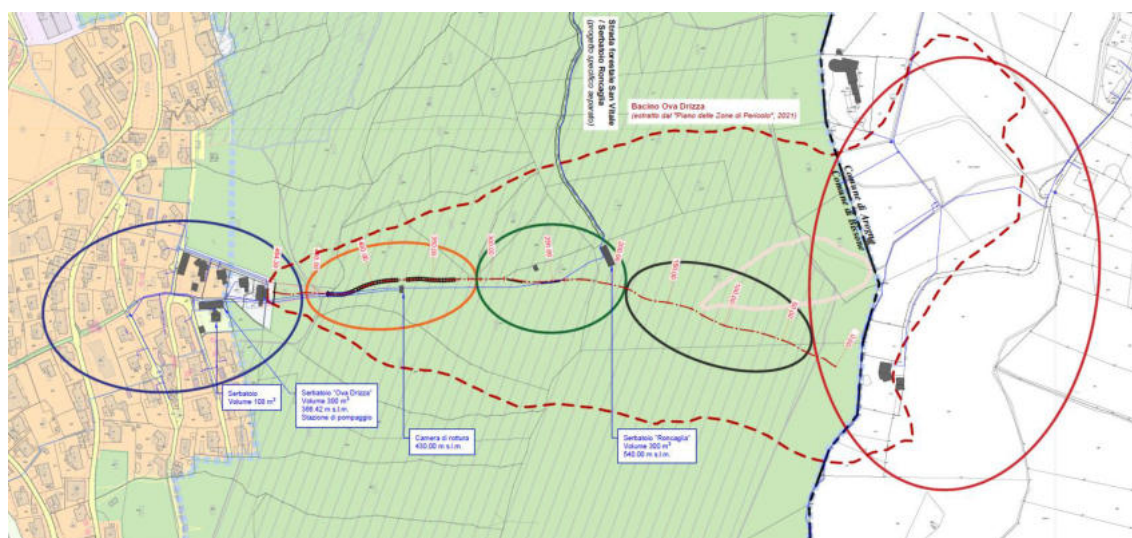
Suddivisione delle aree (estratto dalla planimetria generale allegata).
